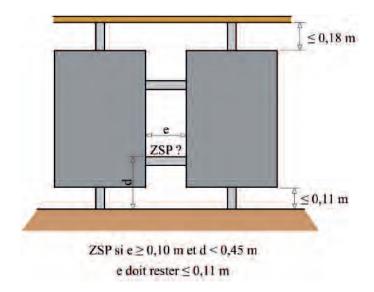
ESPACE ENTRE ÉLÉMENTS HORIZONTAUX
